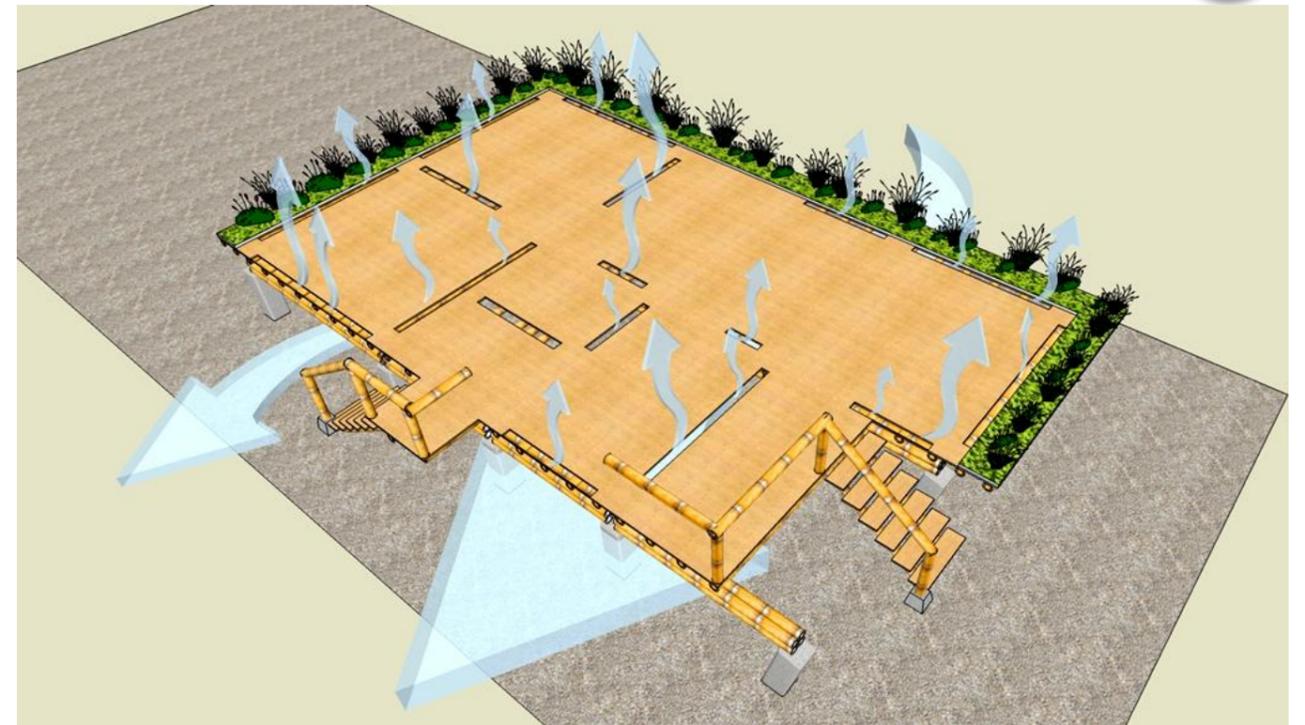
Funcionamiento conceptual del ingreso de ventilación a través del piso de la planta baja para posteriormente pasar por las paredes de la vivienda.
